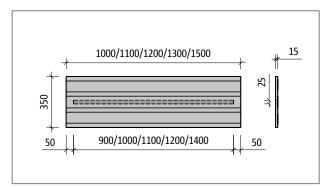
Schöck Tronsole® tipo B-V1-L...-B350, pianta del prodotto
